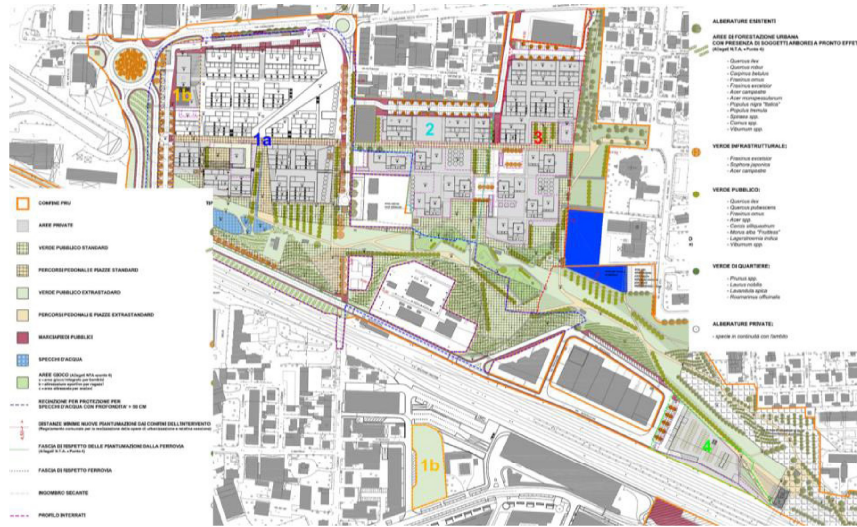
3 - Planimetria verde pubblico (fonte: stralcio tav. 12.1, PRU)
